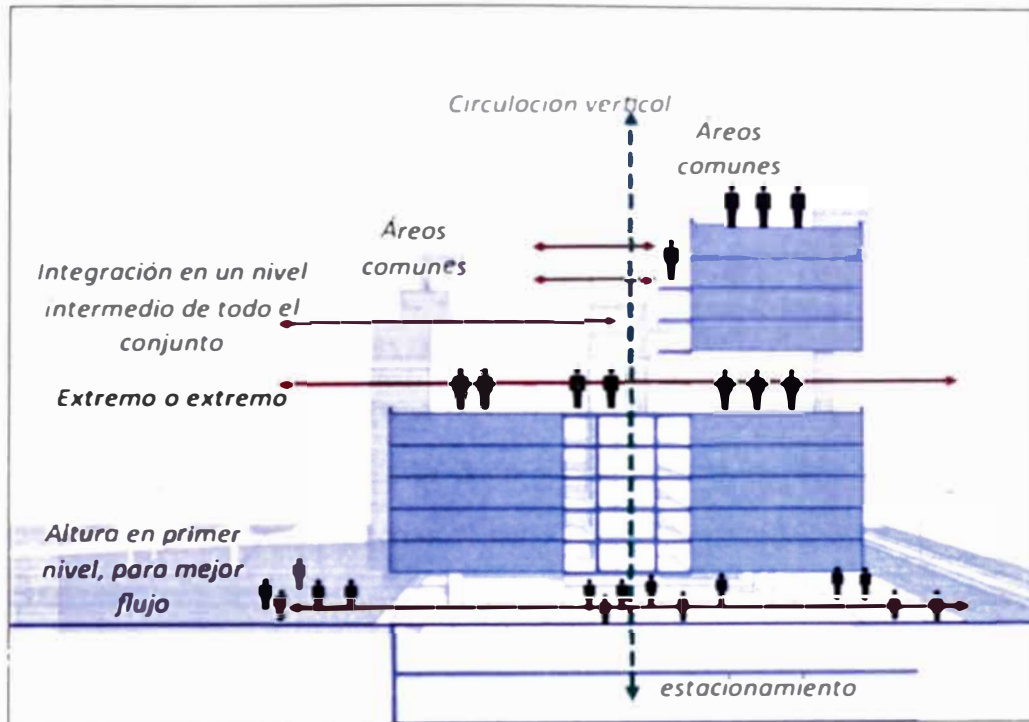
Planteamiento preliminar de la propuesta-fachada hacia parque.
